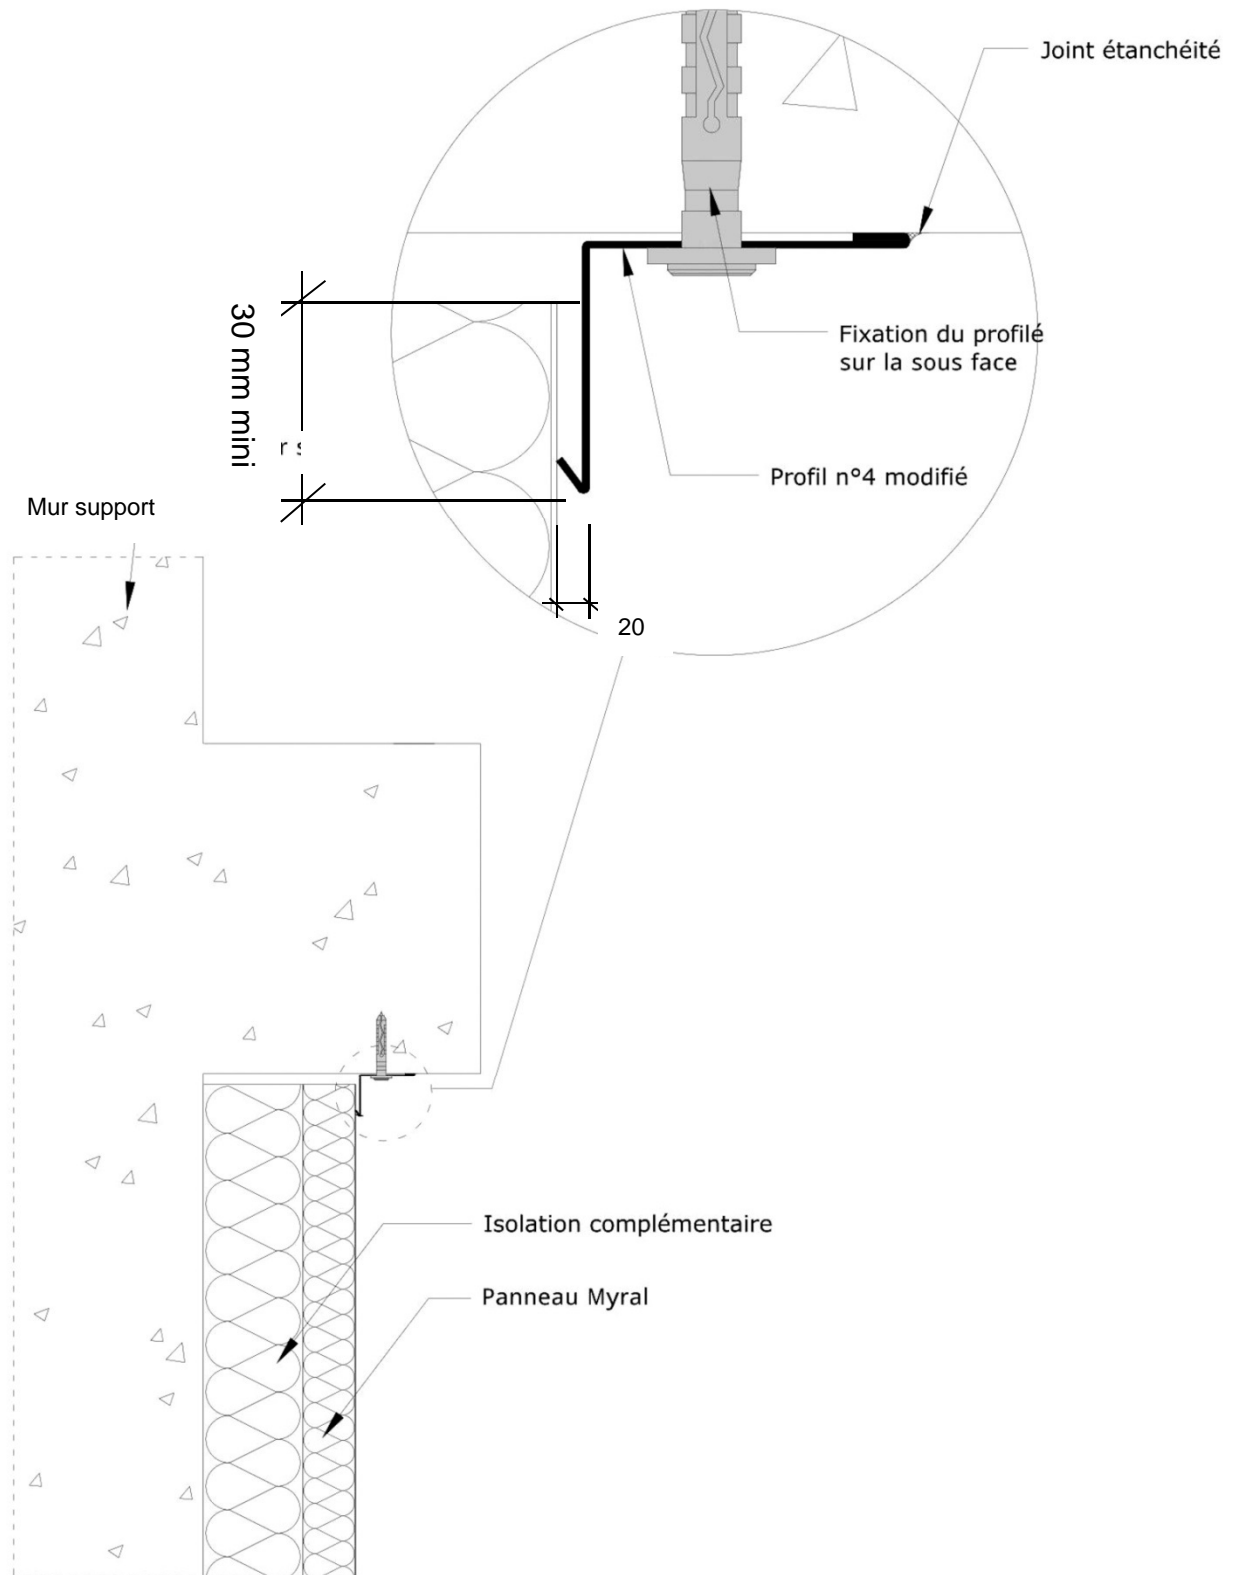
Haut de façade avec nez de dalle saillant – Pose en vêtage (coupe verticale)
